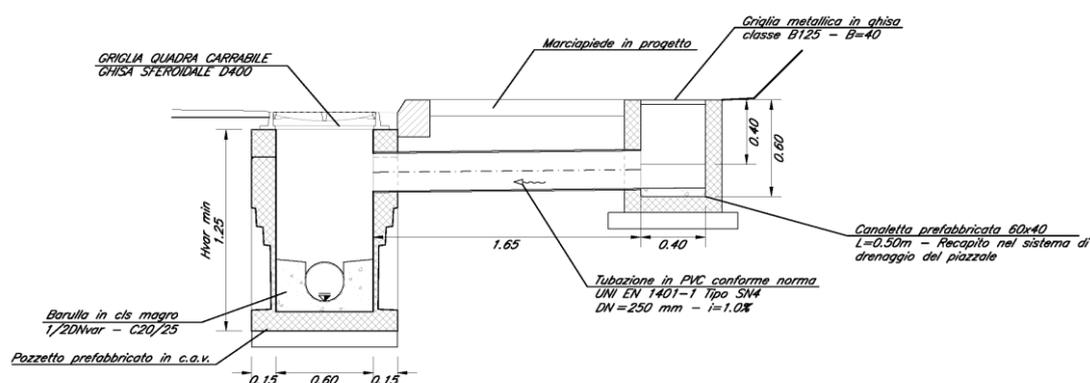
Recapito canaletta rettangolare – Opera tipo
